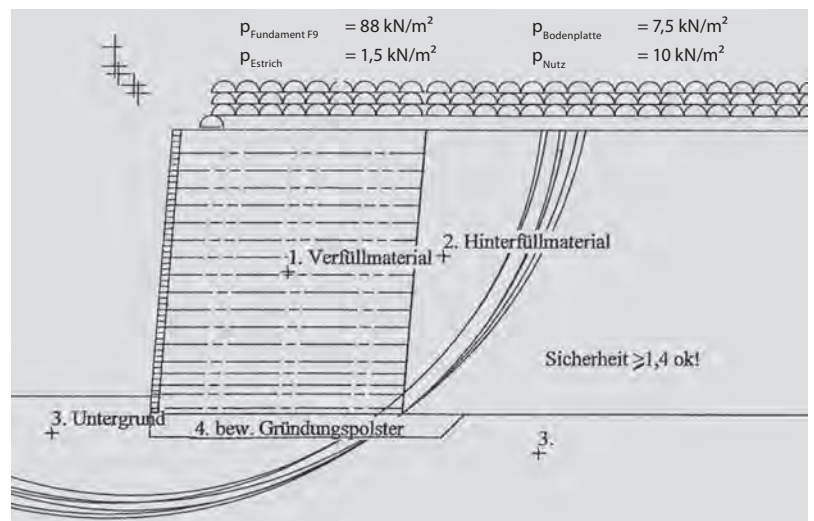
Darstellung der geogitterbewehrten Stützkonstruktion TensarTech® Wall
